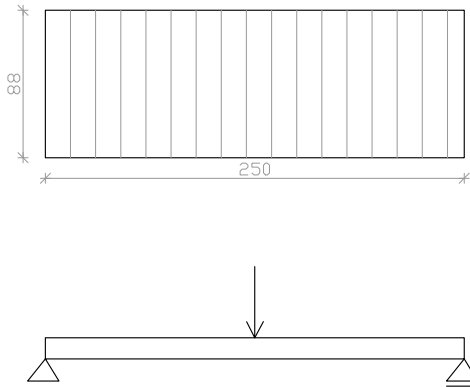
Grundriss und Abmessungen der Tribüne (ganz oben)
